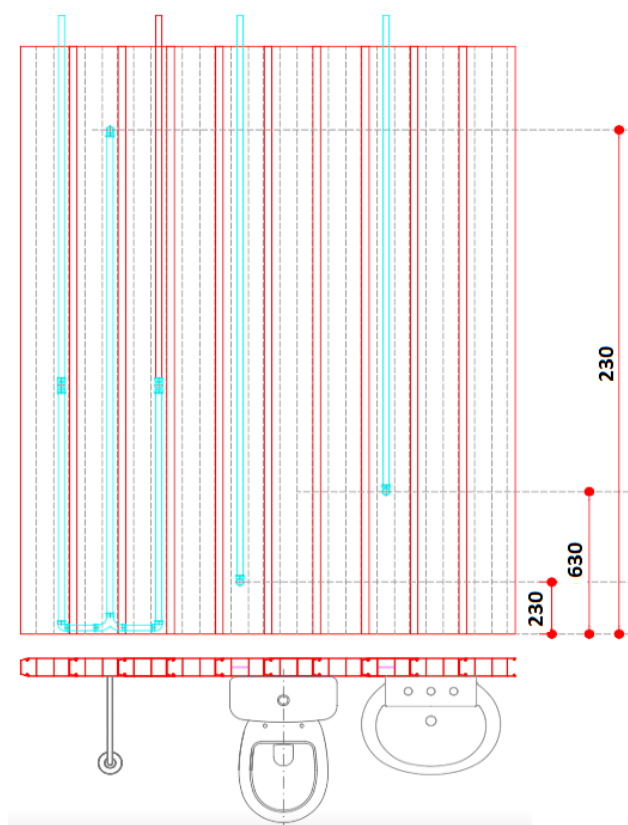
Exemplo de instalações hidráulicas no interior de parede hidráulica do Sistema Construtivo Bazze PVC - elevação e corte transversal da parede. (Sem escala).
